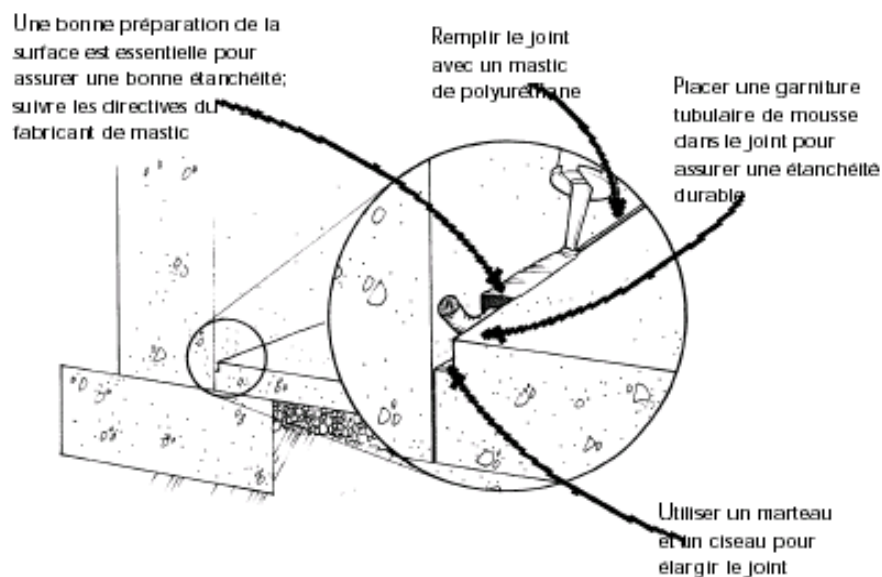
obturation des joints des murs de fondation et des planchers du sous-sol <sup>[Sch-1]</sup>
